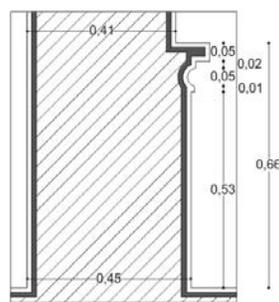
Sección B-B, detalle frontón, Estación del ferrocarril Sur.
